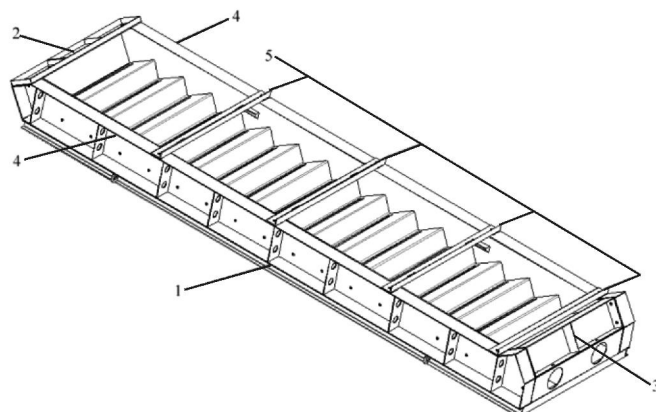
预制混凝土楼梯卧式钢模具示意
